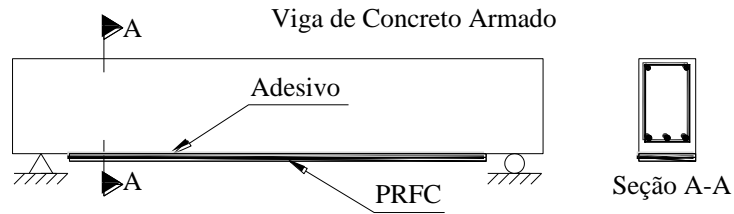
Viga de concreto armado reforçada com colagem de manta de PRFC
